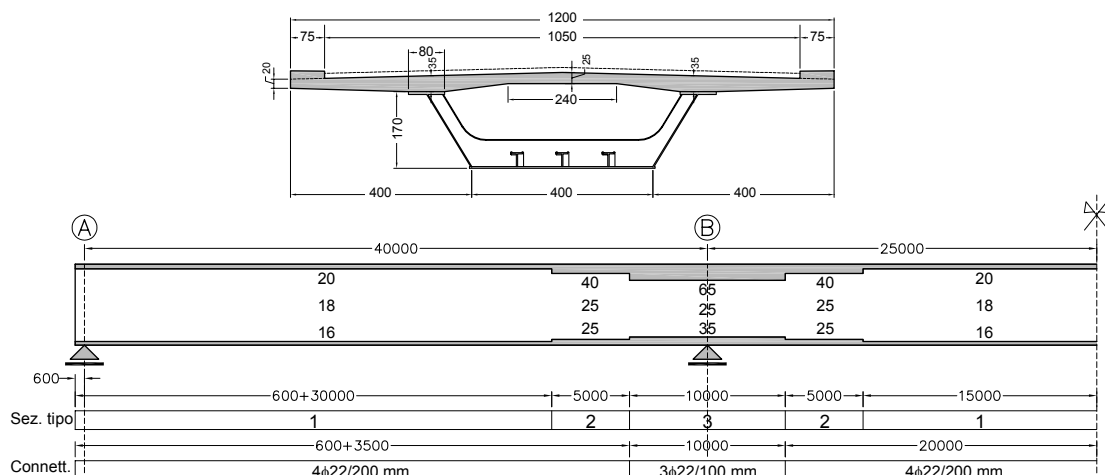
Caso studio: (a) sezione trasversale tipo; (b) definizione della geometria longitudinale, degli spessori delle lamiere e della disposizione dei connettori
